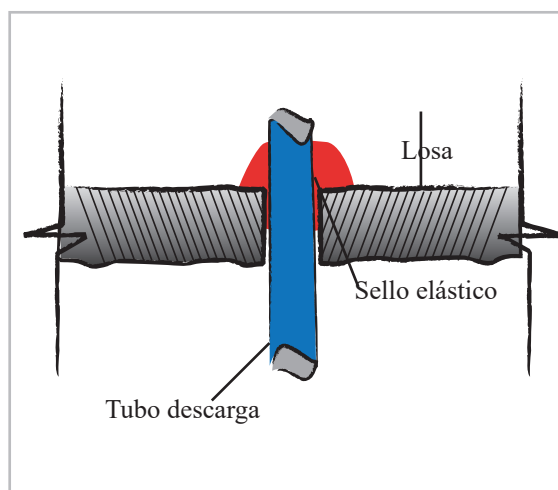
Elementos de protección, encuentro entre losa y tubería
